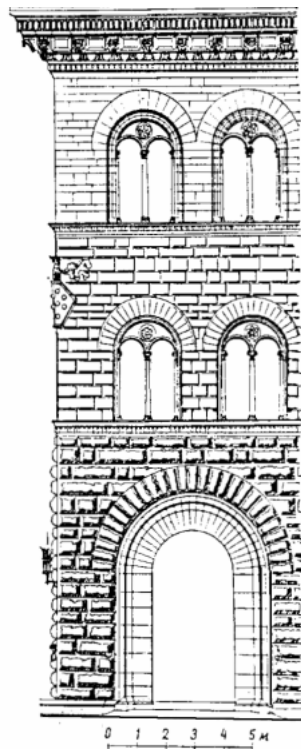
Палаццо Медичі-Рікарді во Флоренції, фрагмент фасада стіни першого поверху. Рустований камінь
